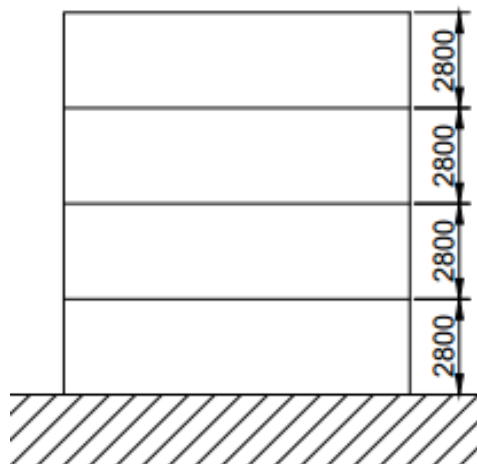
Esquema do pórtico principal (unidades em mm)
